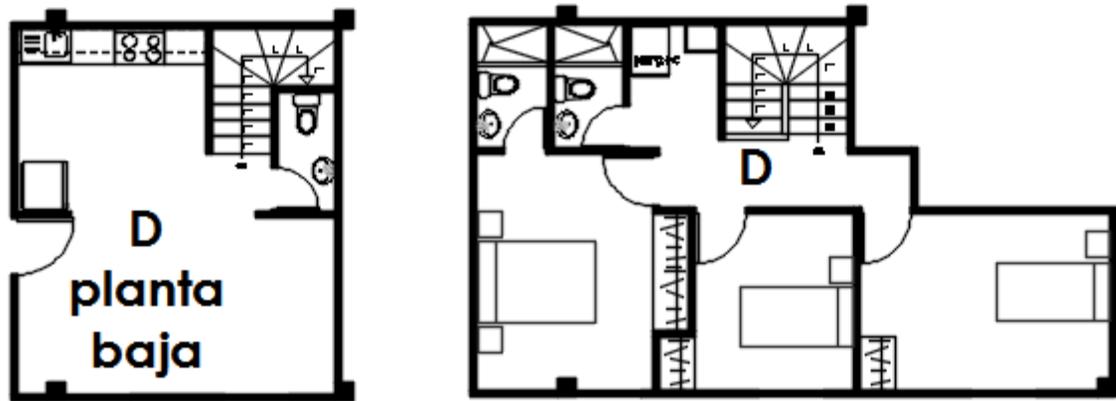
Planta arquitectónica departamento D conjunto residencial "Praderas de Bemani".
